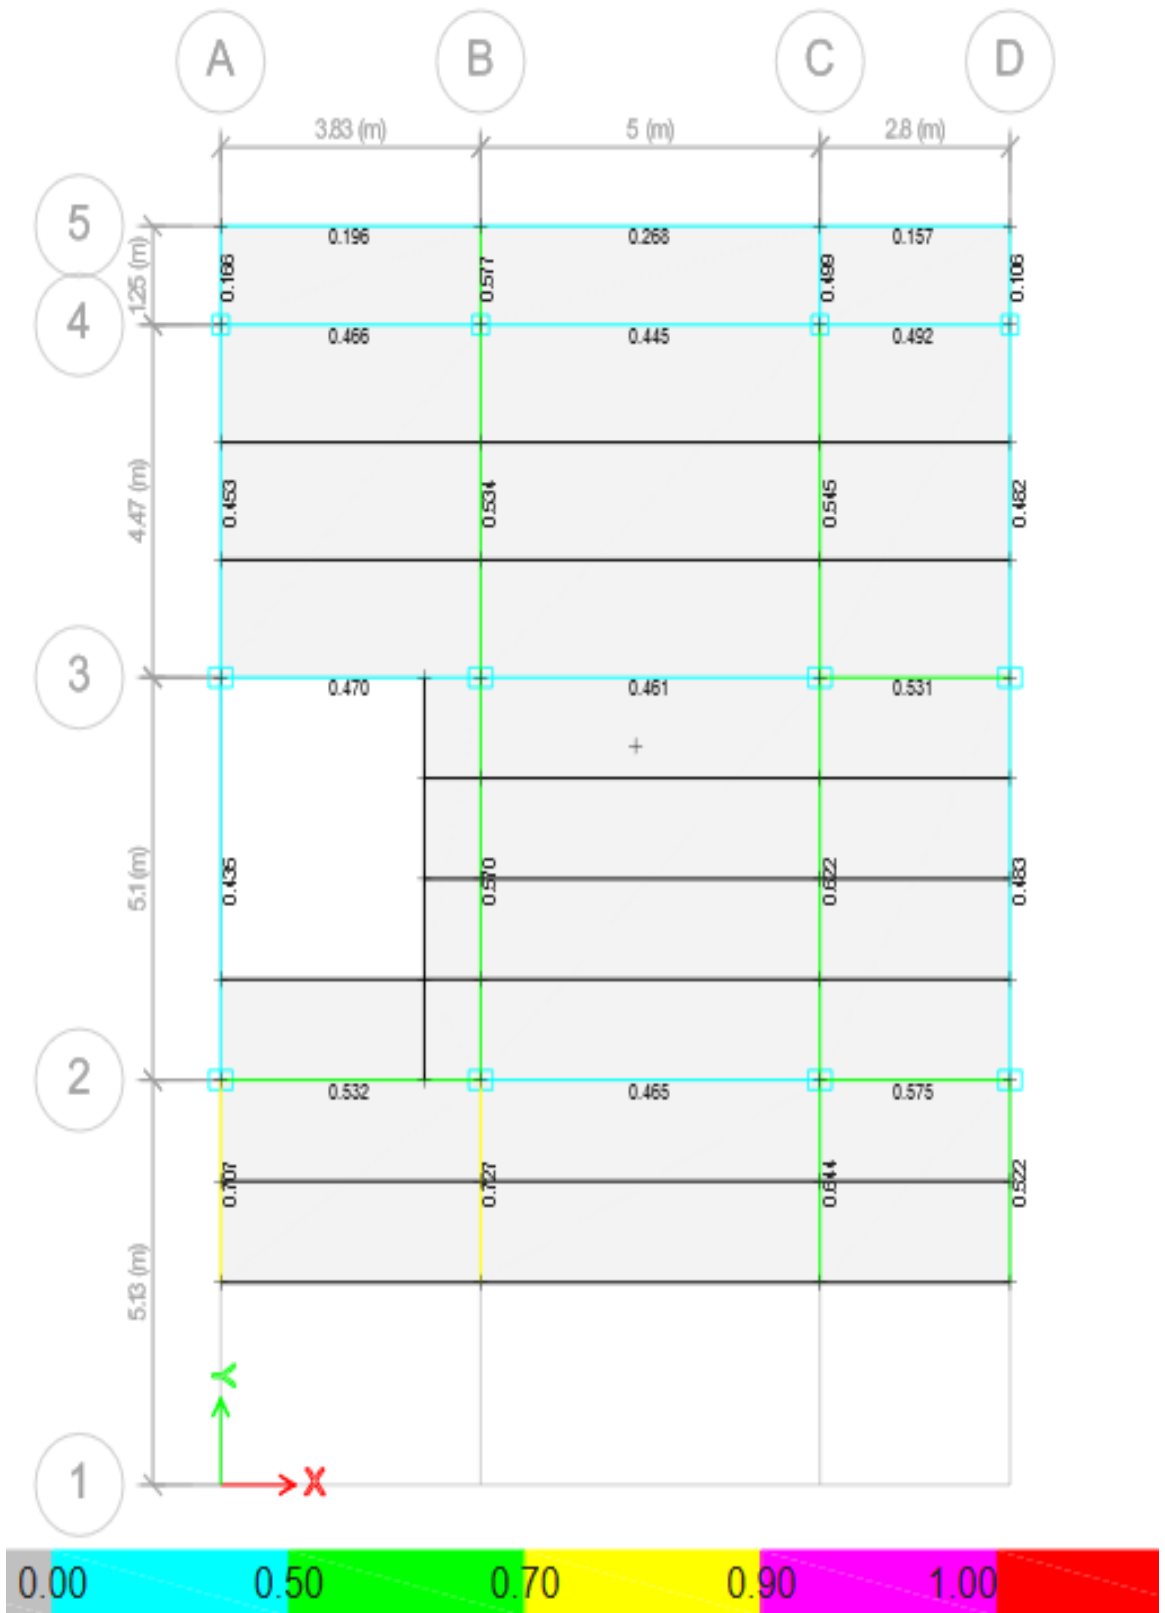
Vista en planta Nv.+12,42 de secciones principales, con diseño AISC 360-16 demanda/capacidad
